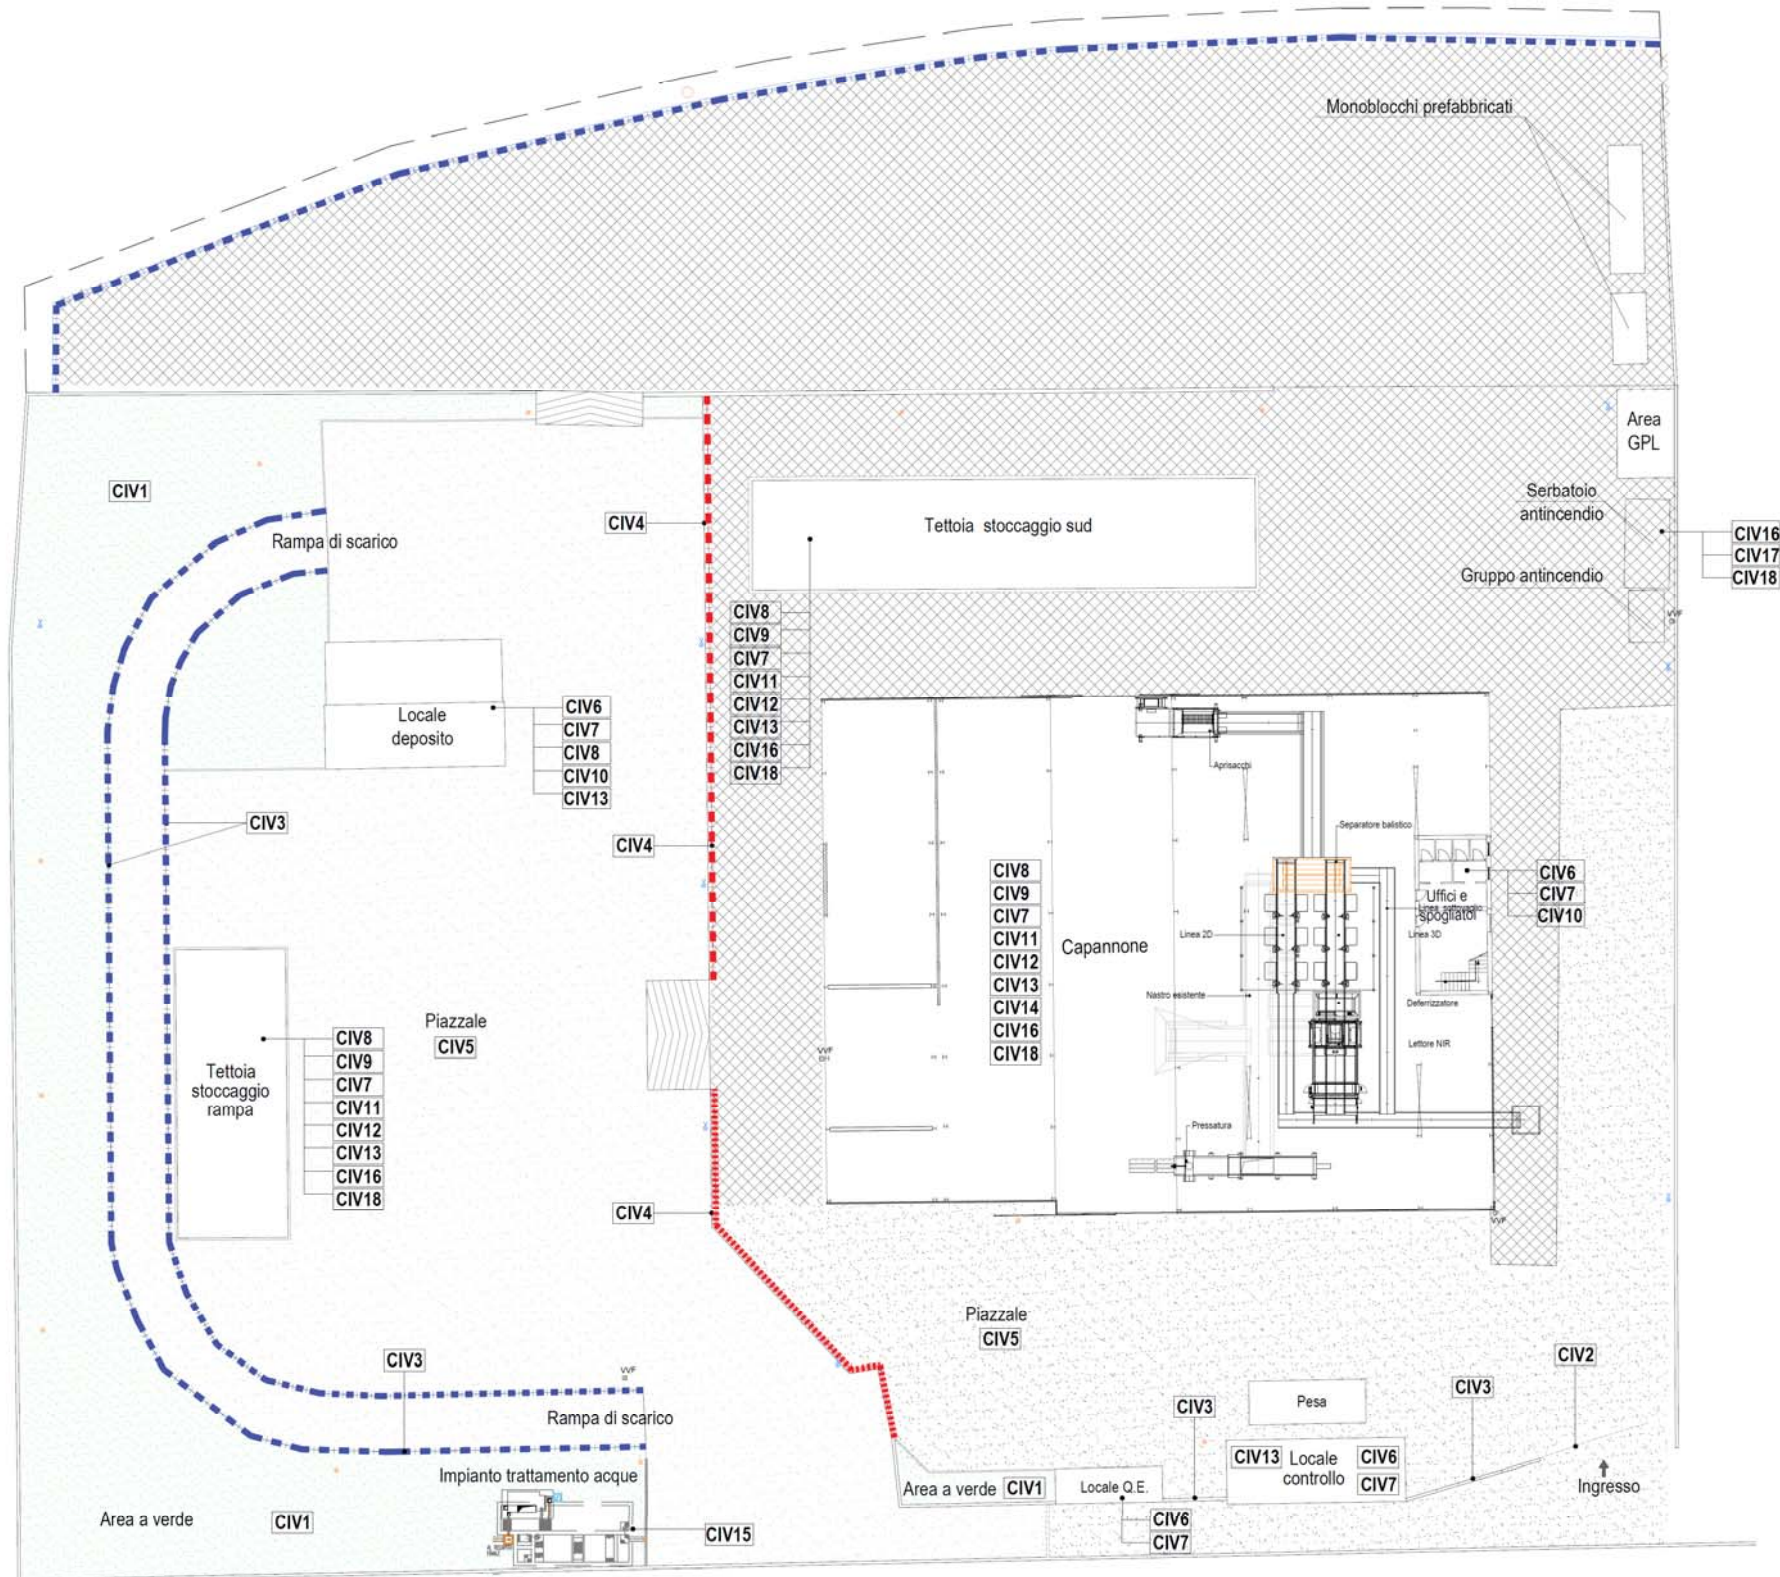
Planimetria di progetto con indicazione degli interventi (CIV)
